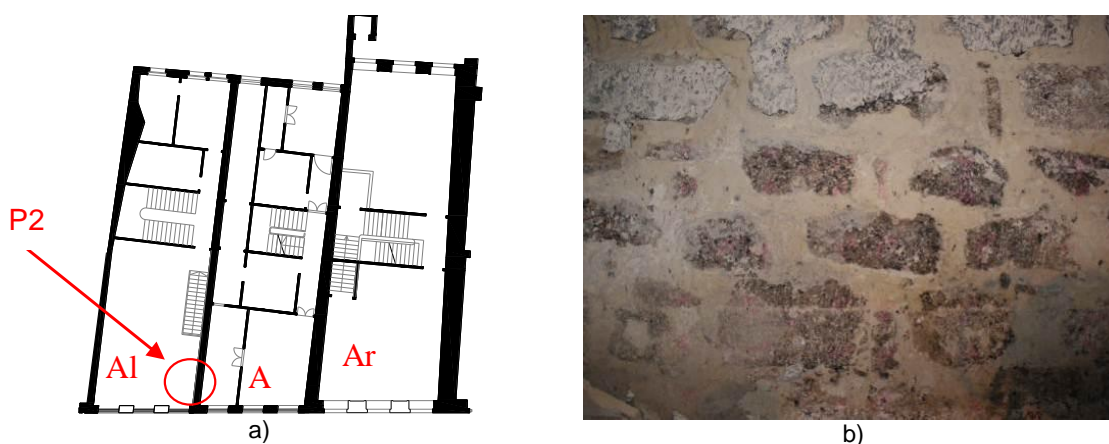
Localização do ensaio com macacos planos: a) planta esquemática; b) aspecto da alvenaria ensaiada.
